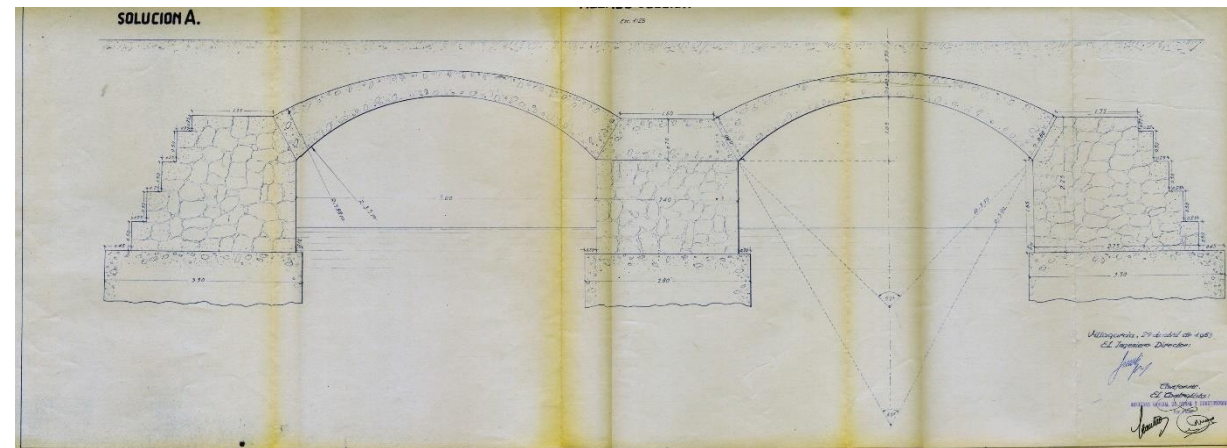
Croquis con la sección del puente (fuente: Puerto de Vilagarcía de Arousa, plano del proyecto original)
